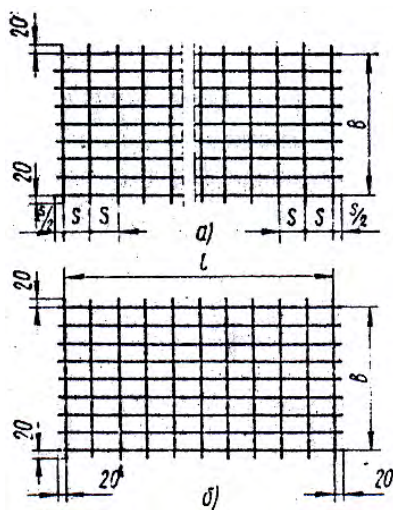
Рулонная (а) и плоская (б) сварные сетки армирования железобетонных конструкций
